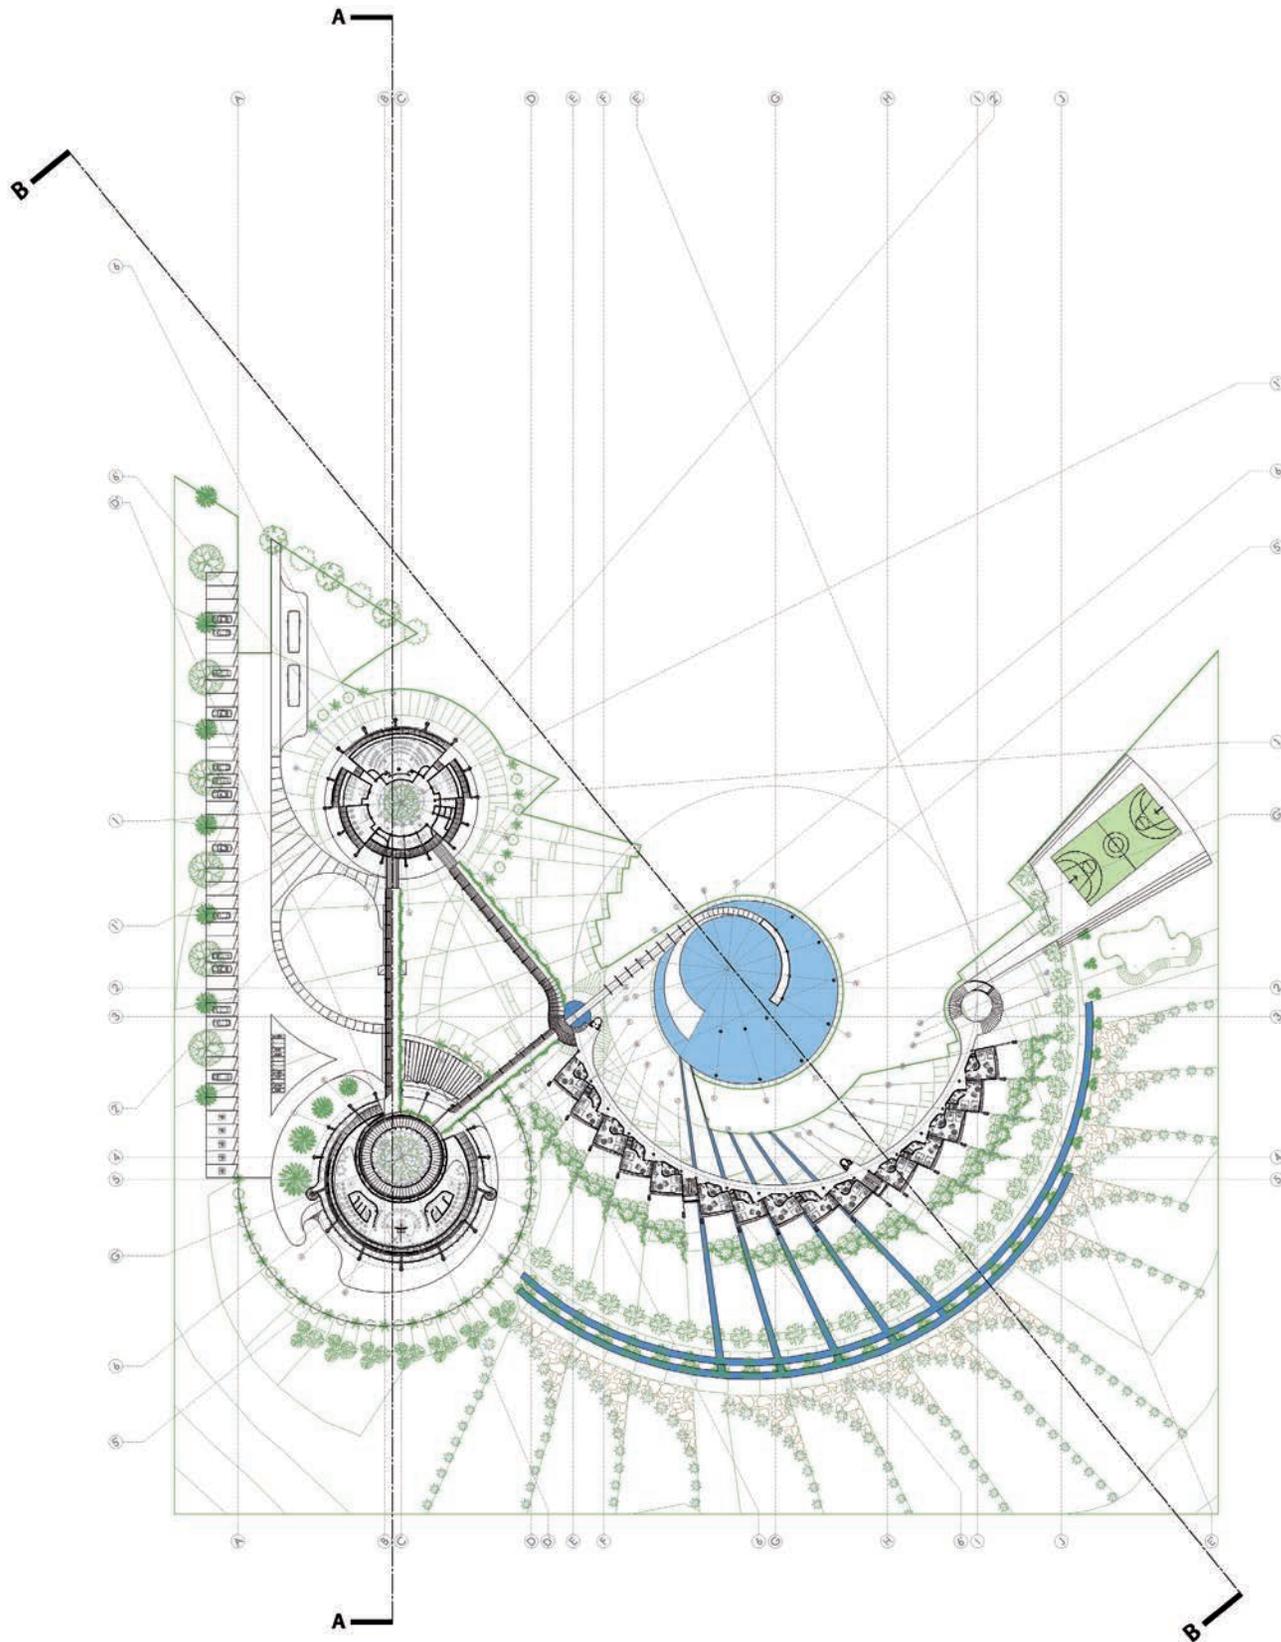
Planta Arquitectónica Nivel 3, 0+9,65 m snt. Fuente: propuesta personal, 2013.
